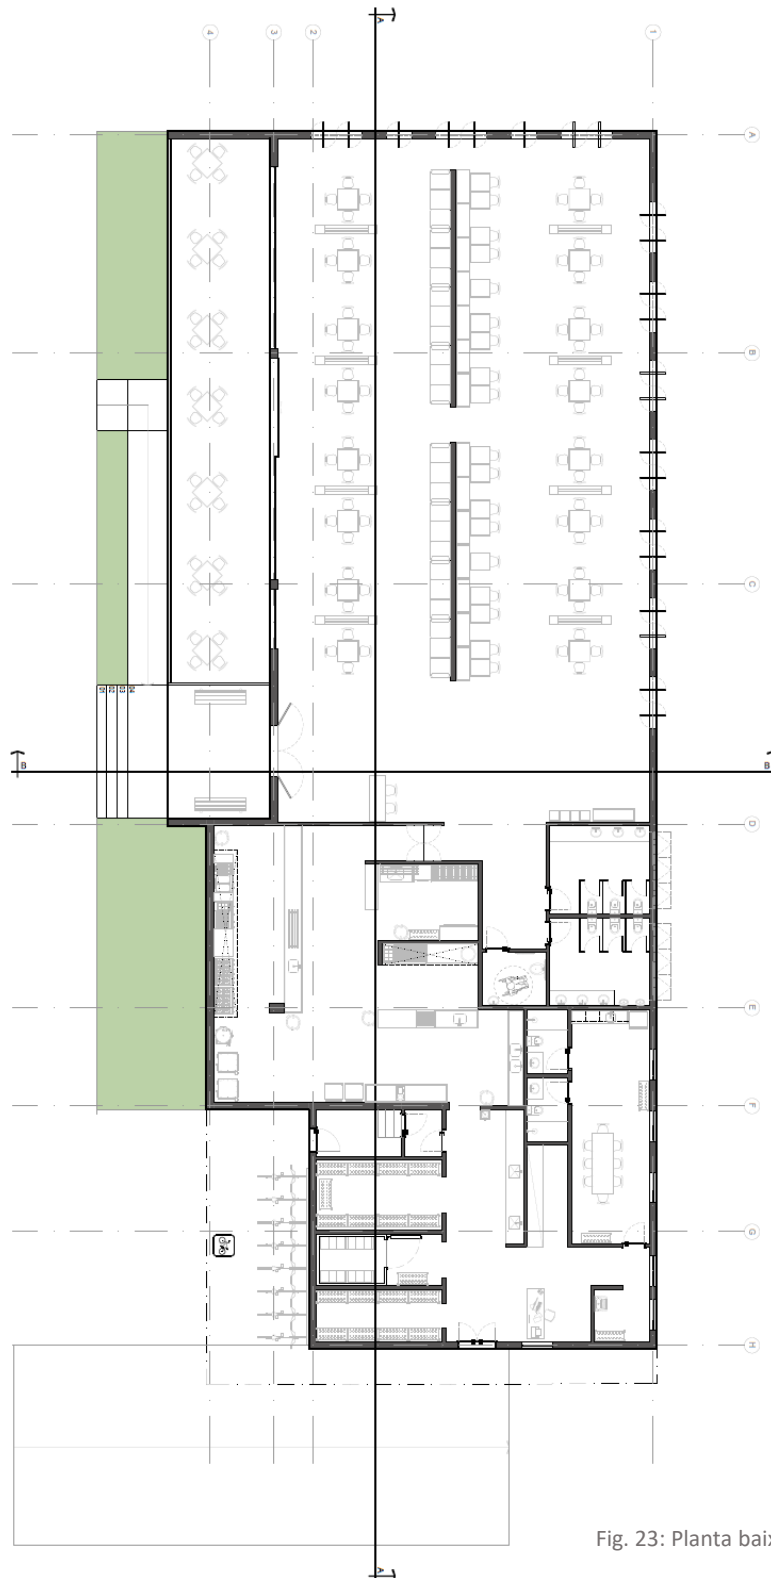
Planta baixa do equipamento 1 (Restaurante).
